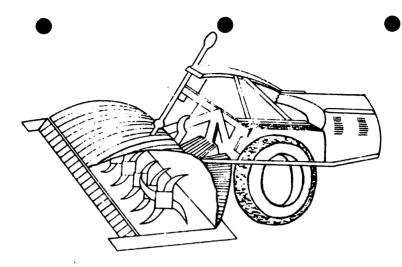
Equipo pulverizador de Suelos y mezclador de estabilizantes. (Pulvomezclador).
